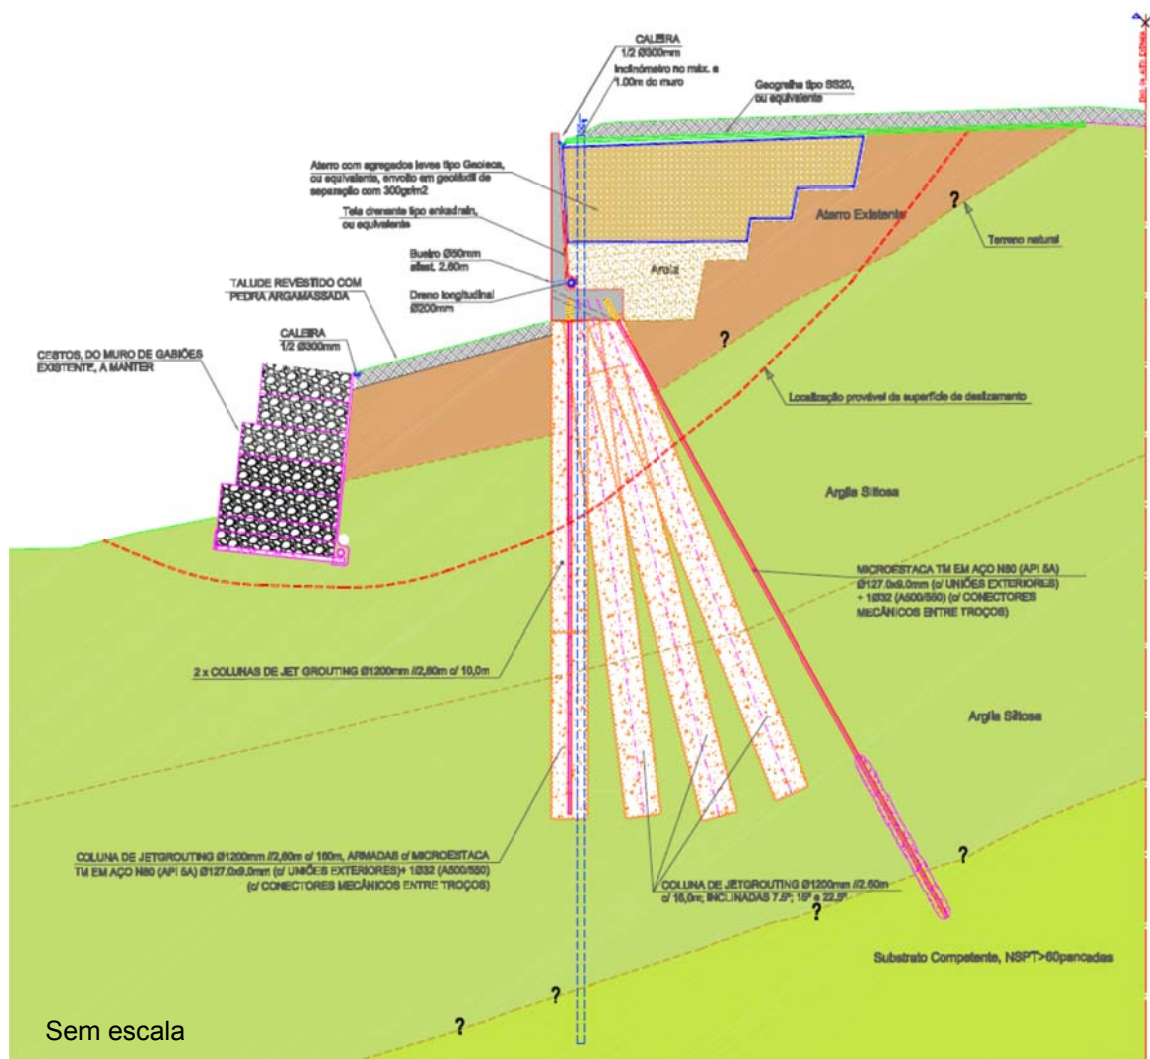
Corte tipo da solução adoptada para a estabilização do aterro da auto-estrada [3].
